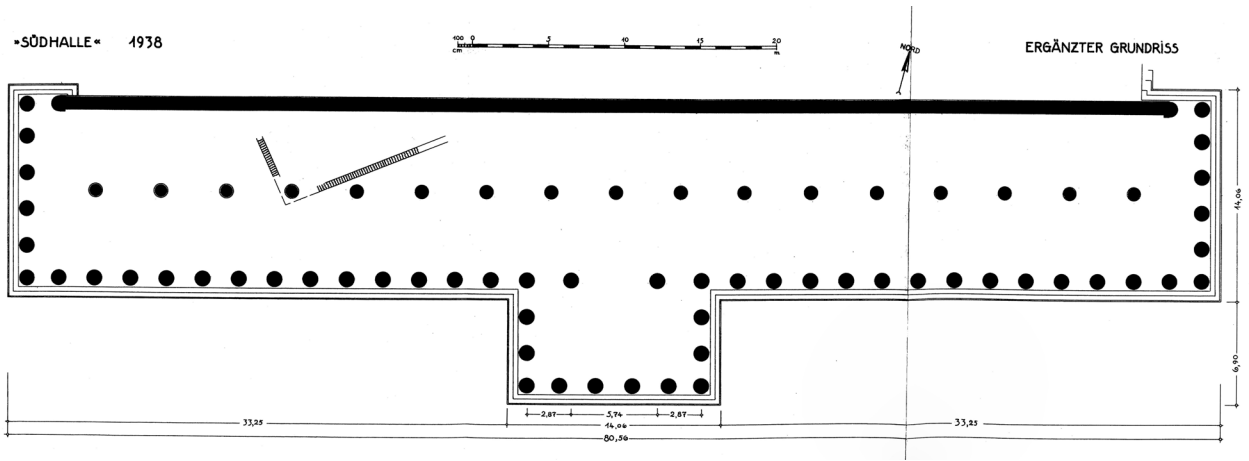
Rekonstruierter Grundriss der Südhalle (M. 1 : 500)
